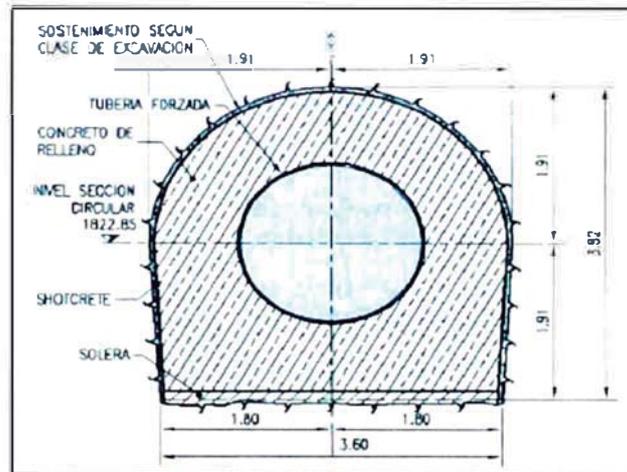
Sección Tipo I – Relleno Tubería Forzada
